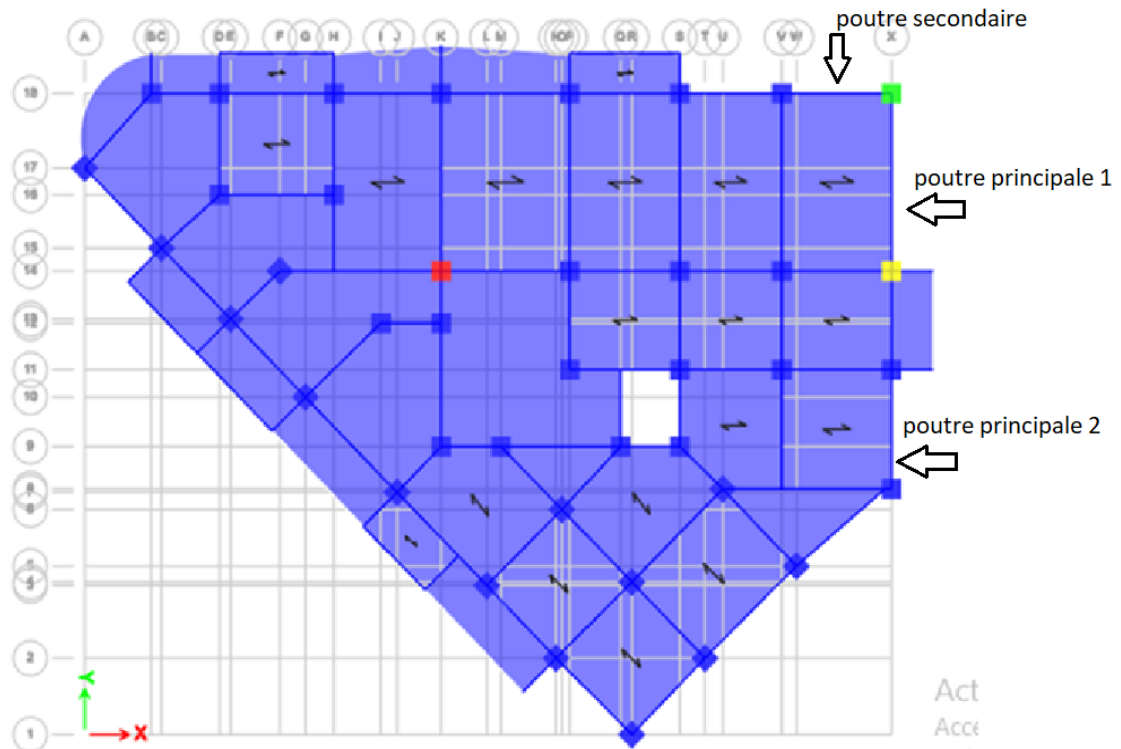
Vu en plan des poteaux les plus sollicités.
